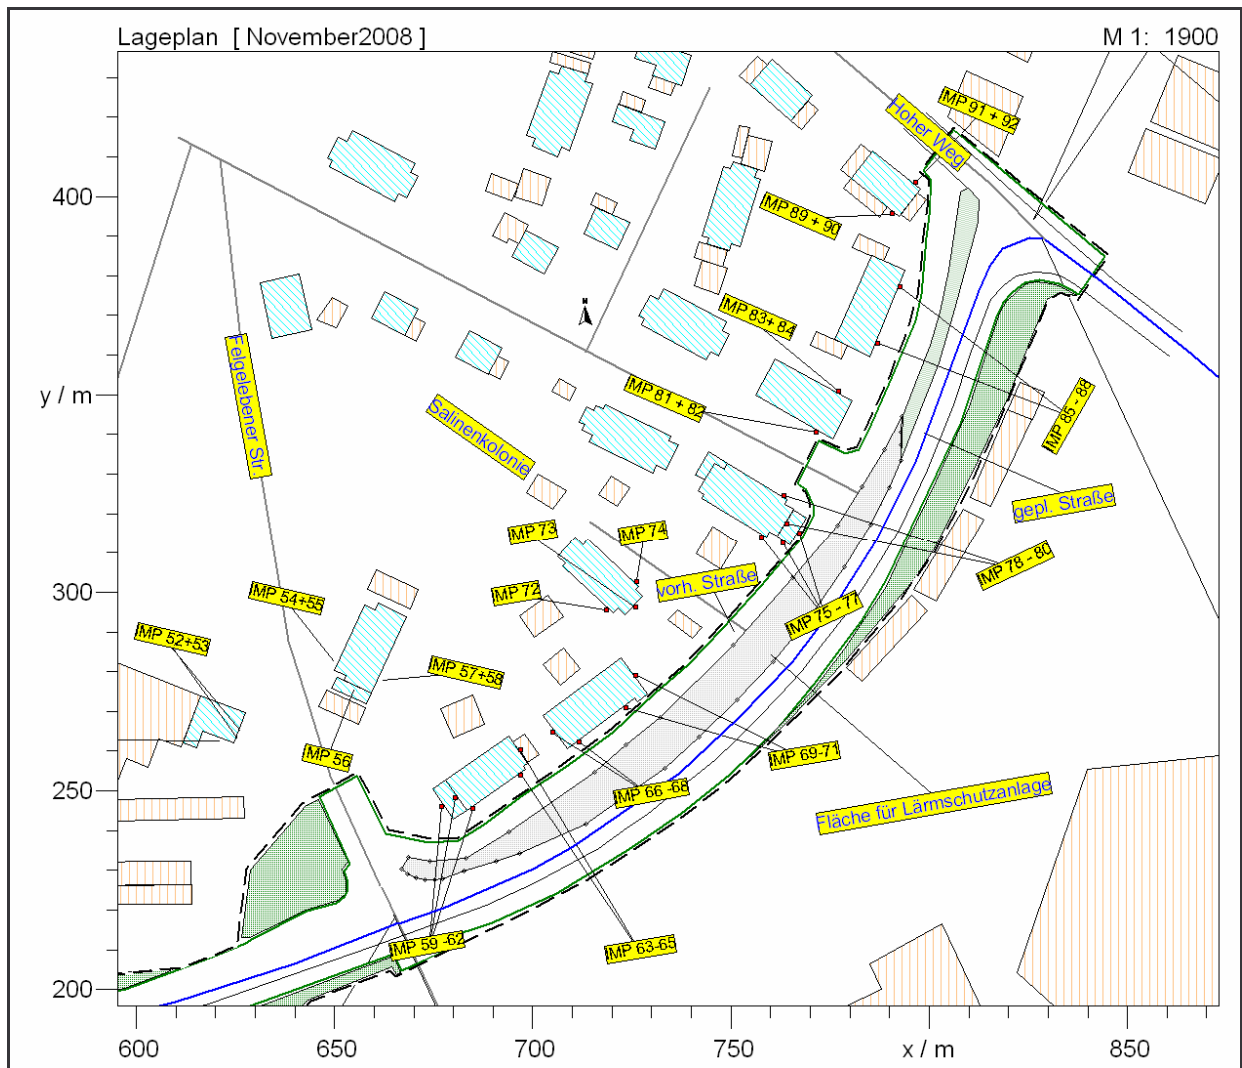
B-Plan Nr. 11 Zentrumsumgehung“ 2. Änderung – Ausschnitt - mit Lage der geplanten Fläche für eine Lärmschutzanlage
